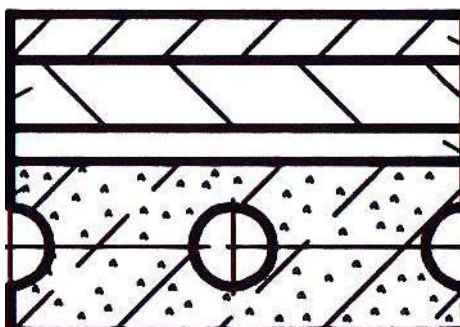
Эскиз чердачного перекрытия
